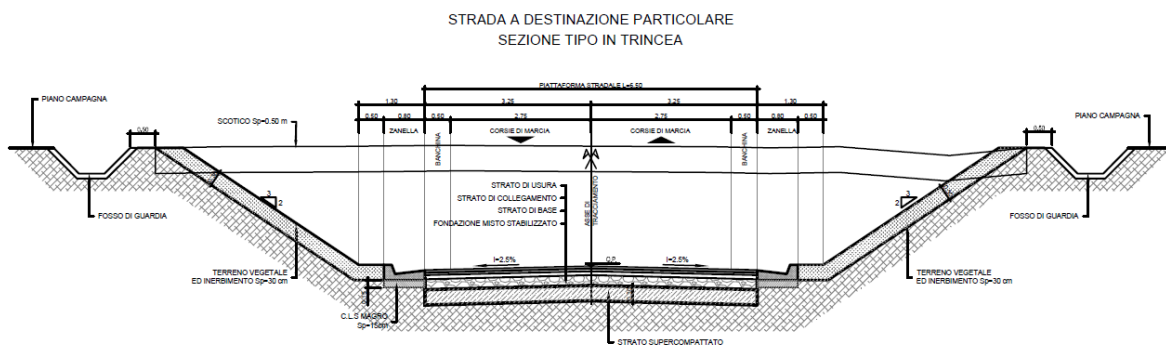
Sezione tipo trincea – strada a destinazione particolare
